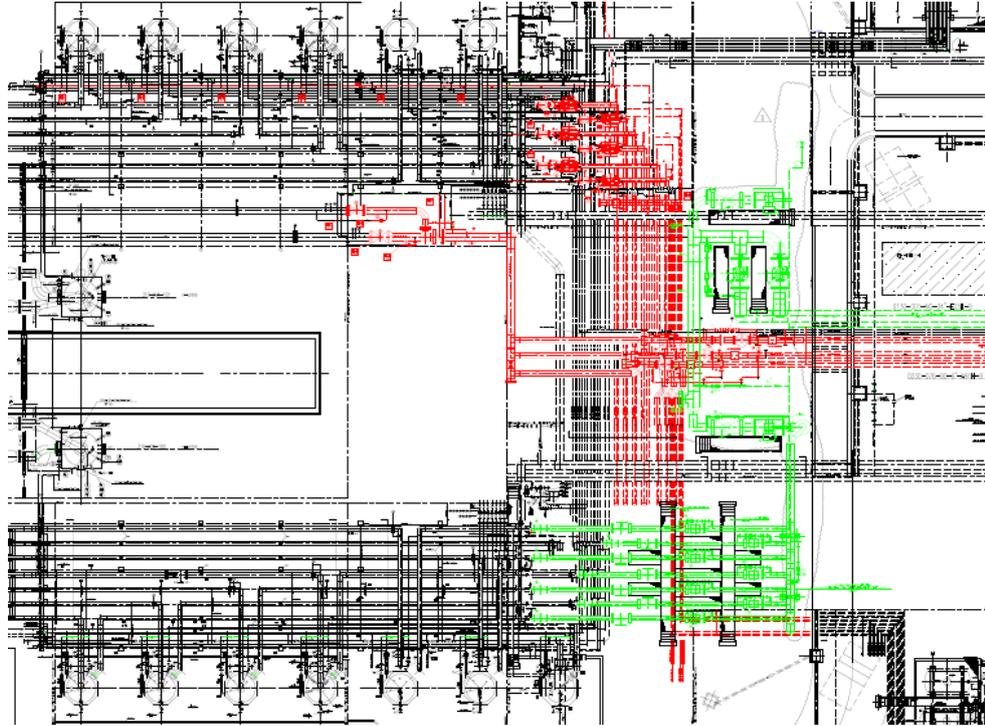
Planimetria Tie-ins di Centrale – Fase 2 (in rosso smantellamenti Fase 2, in verde nuove installazioni Fase 1)
